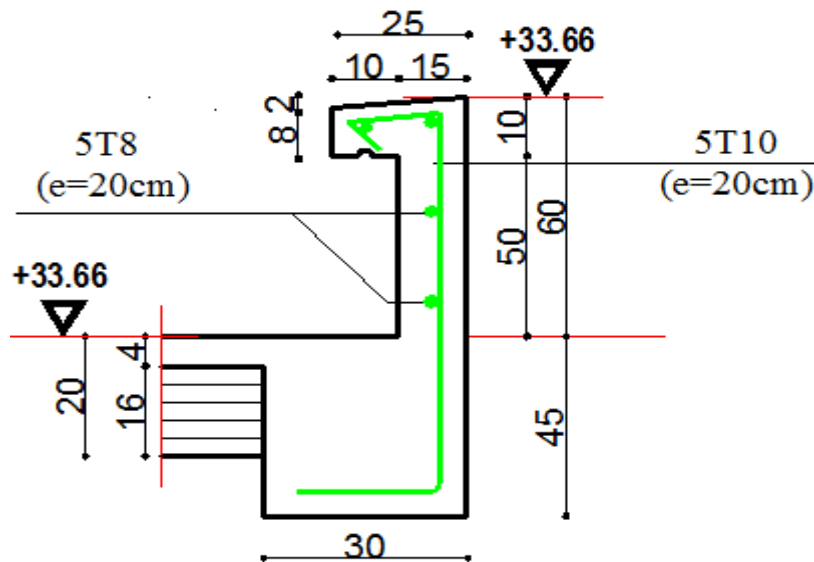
Schéma de ferrailage de l'acrotère.
